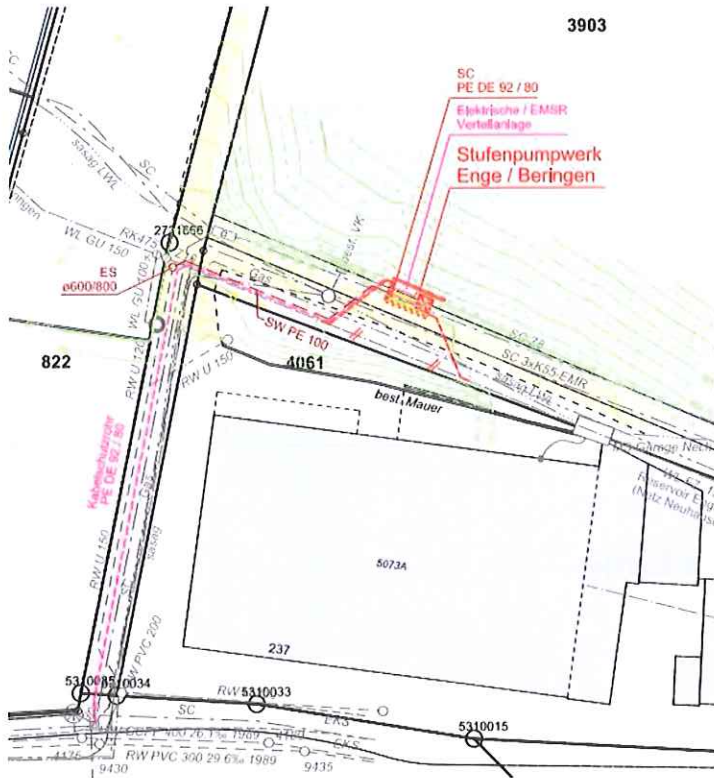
Ausschnitt Baueingabeplan, Gujer AG, 8153 Rümlang
